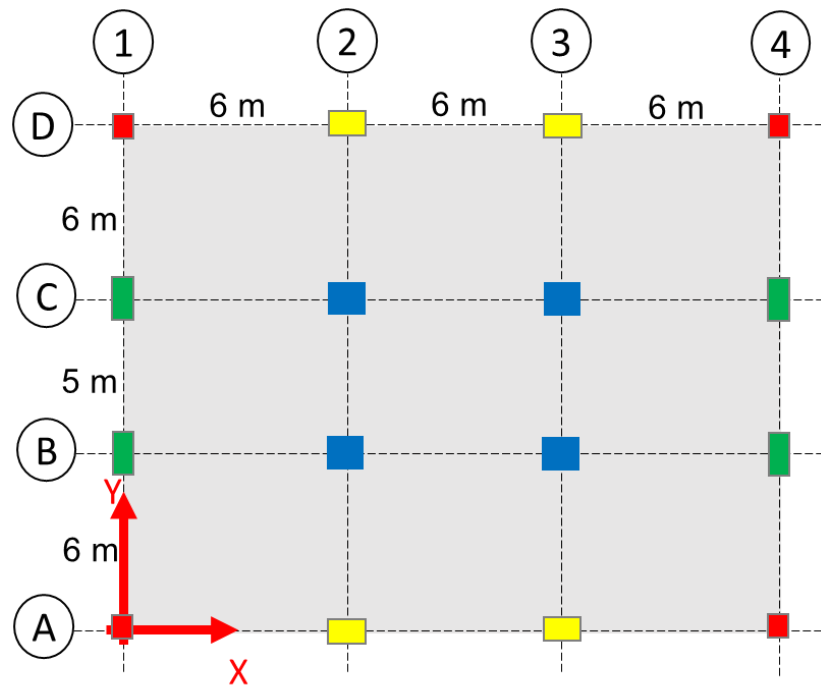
Plano de planta para ubicación de columnas y sentido de las mismas.
